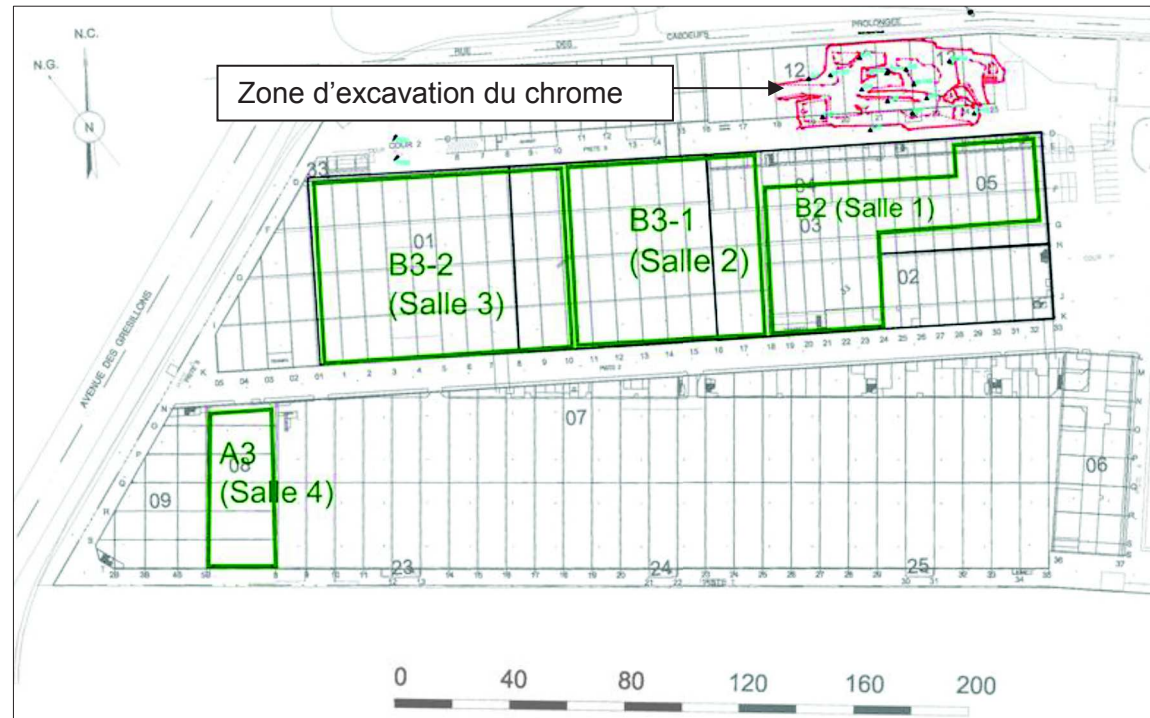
Plan d'implantation des excavations de terres polluées au chrome VI
